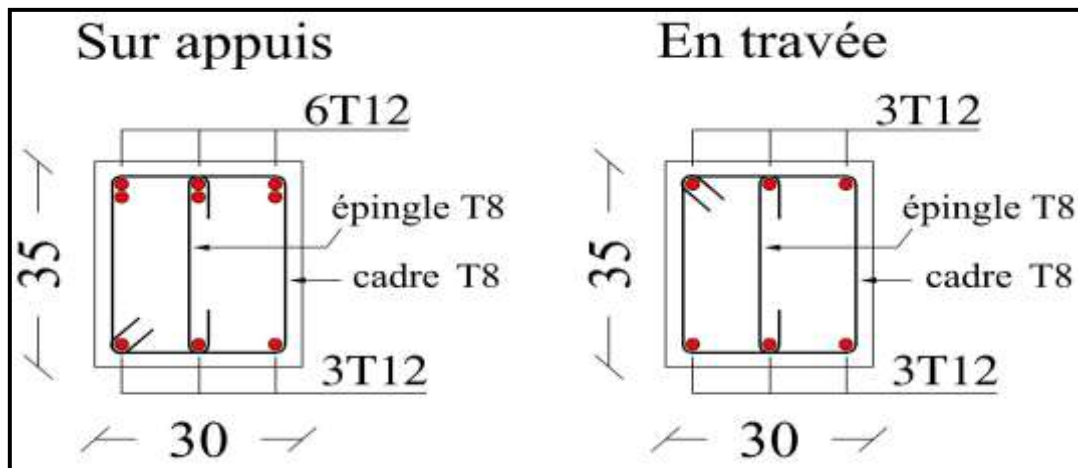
Schéma de ferraillage de la poutre de la rampe
